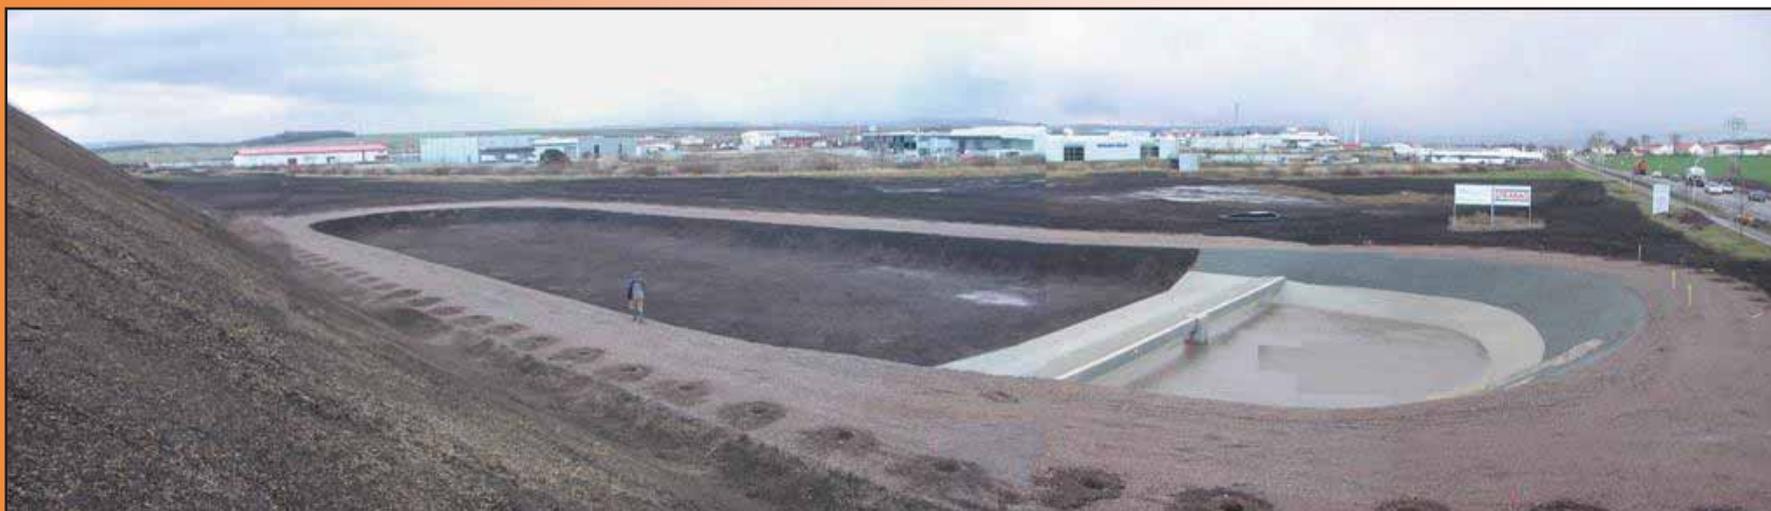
idem a lavoro e rinverdimento ultimato. Separazione tra Autostrada ed AV TO – NO
